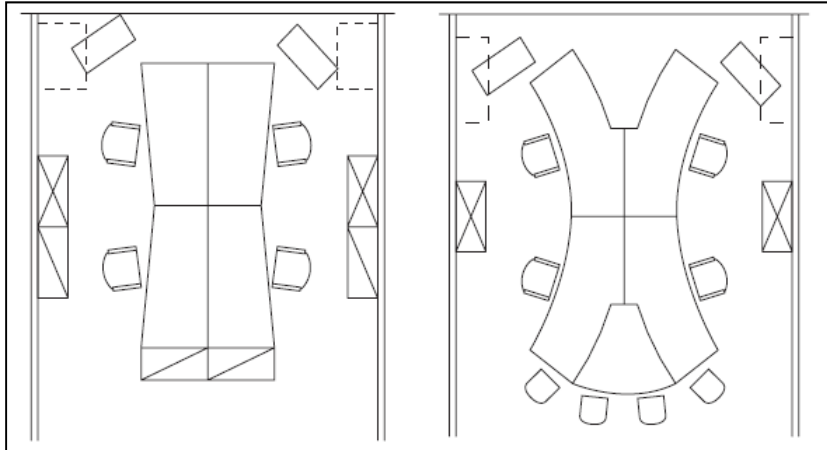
Beispiele für Grundrisse von Gruppenbüros mit Orientierung zueinander²⁴
